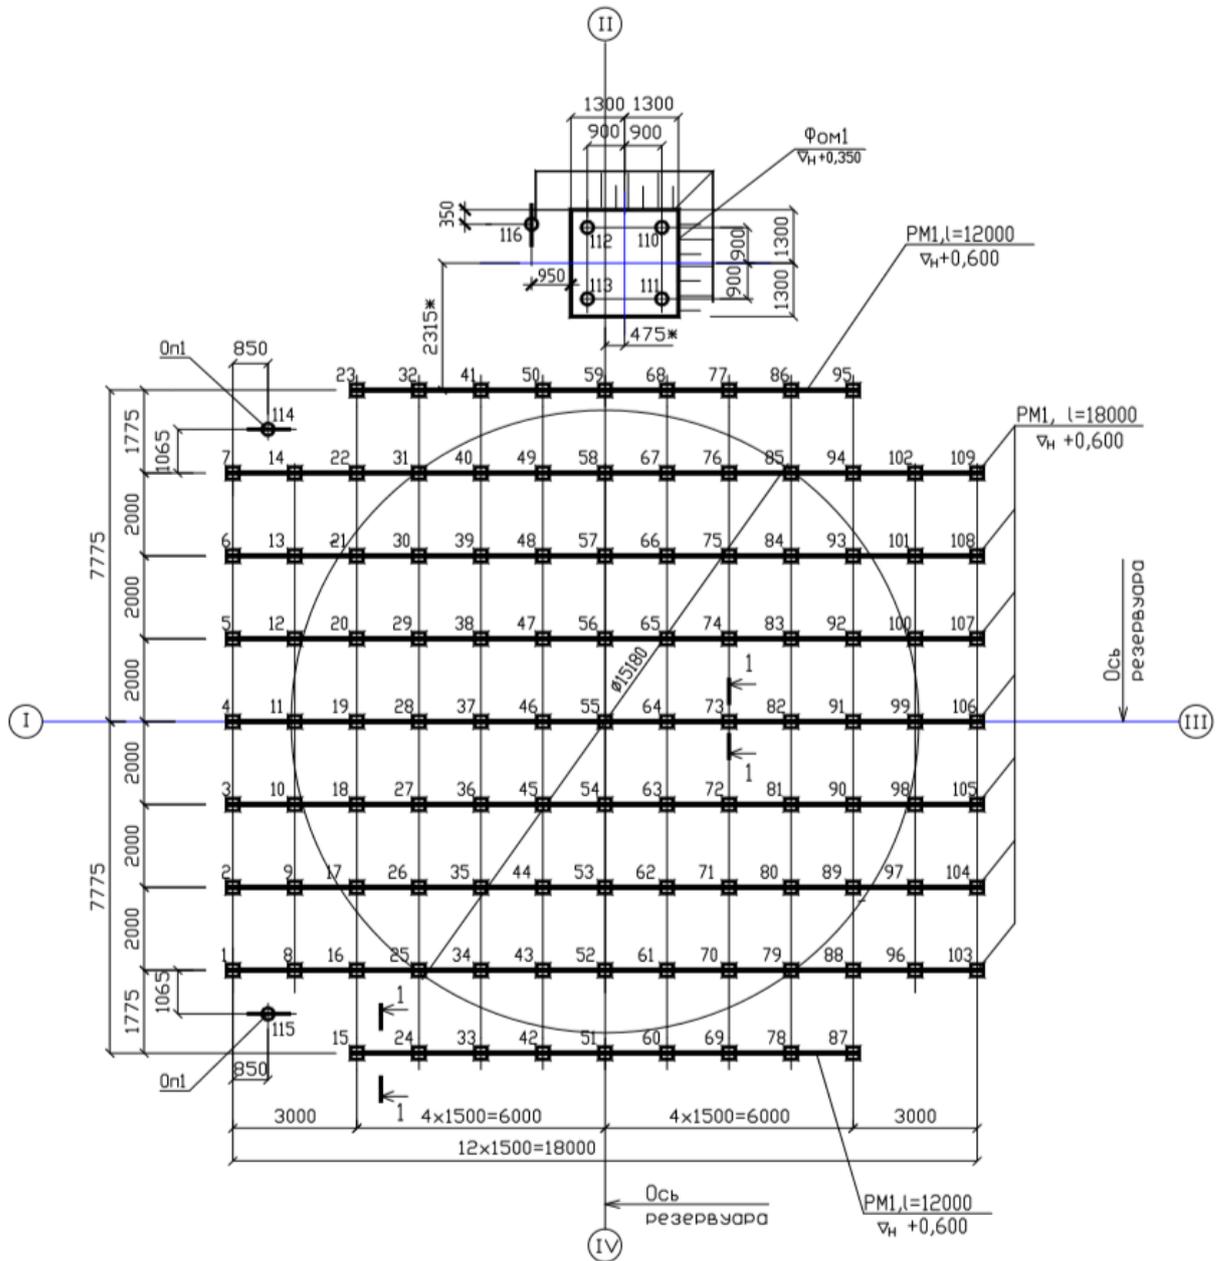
Исполнительная схема сваренного поля для установки резервуара РВС-1000
